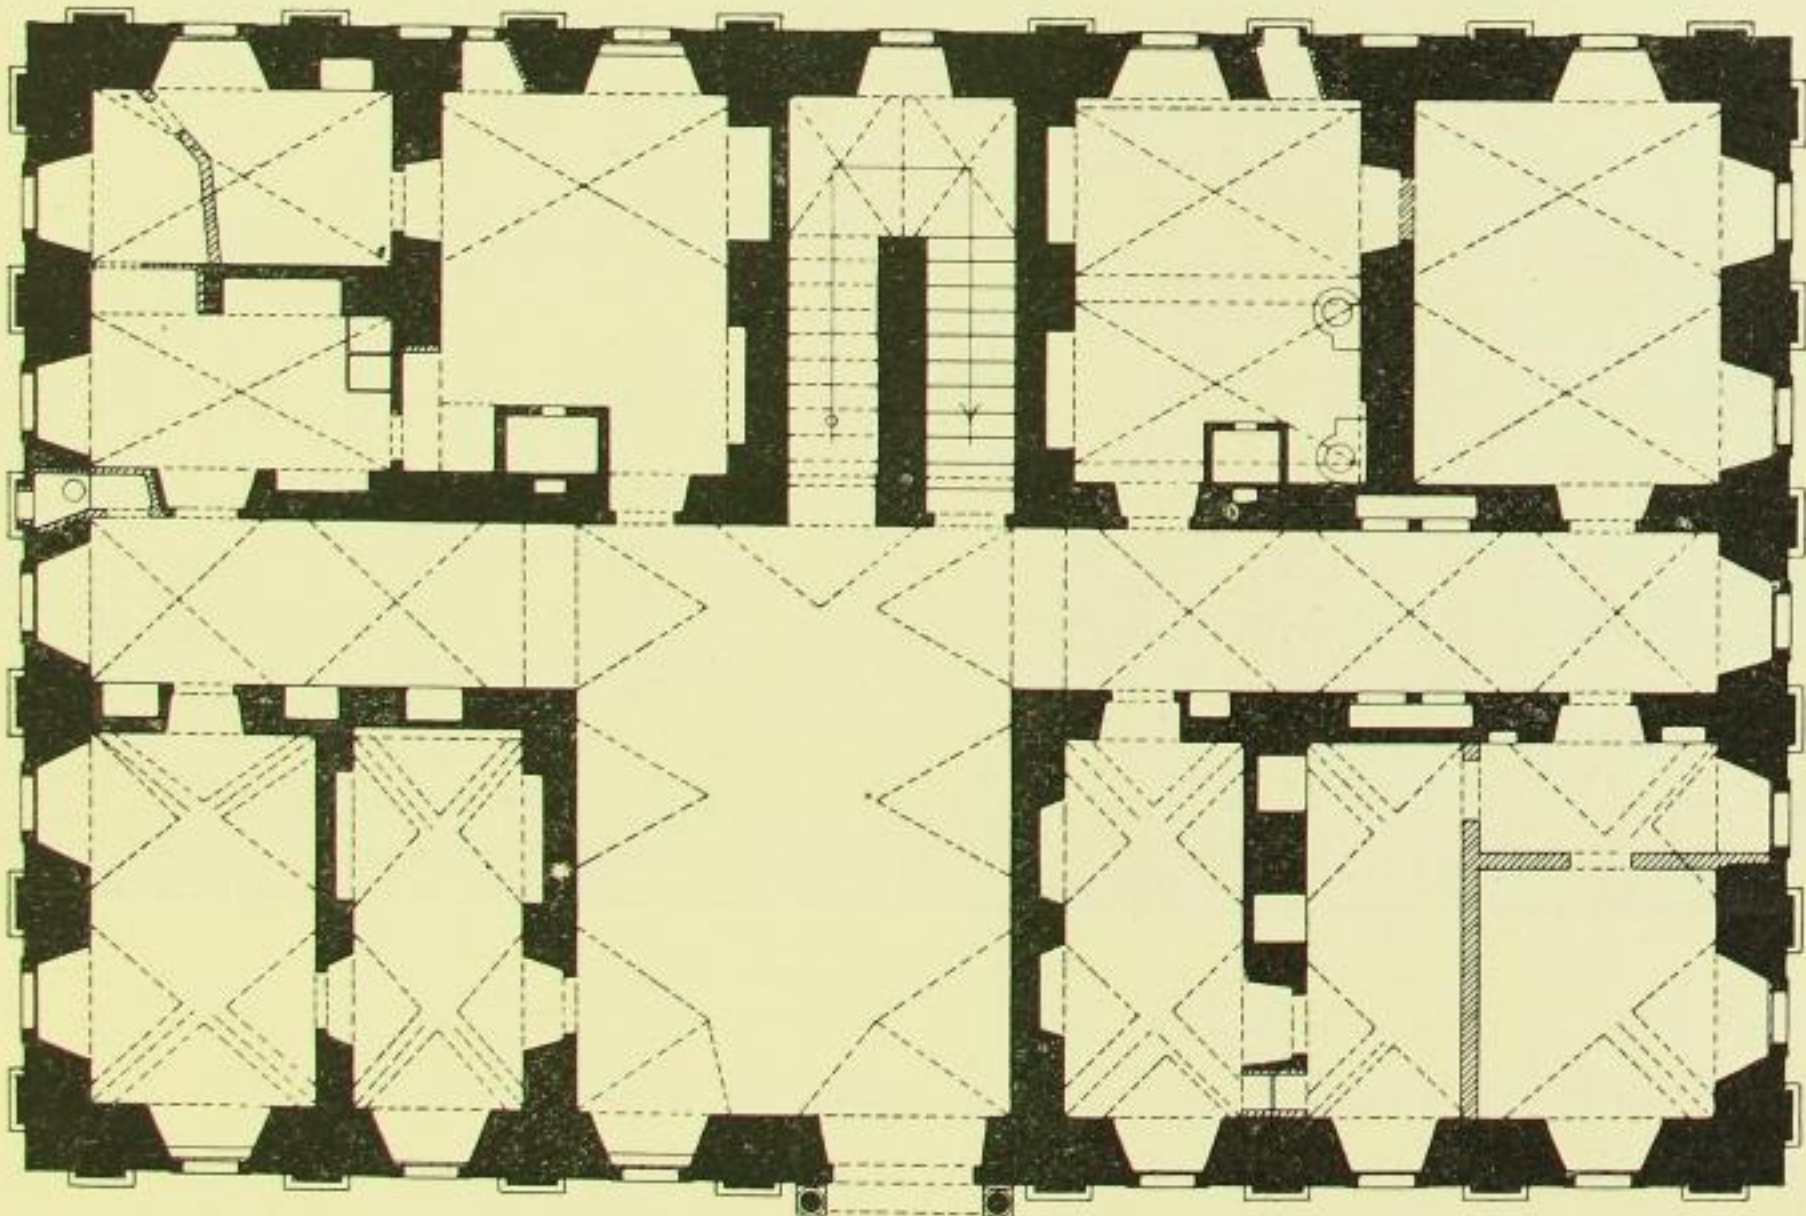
Gießmannsdorf, Schloß, Grundriß des Erdgeschosses.
